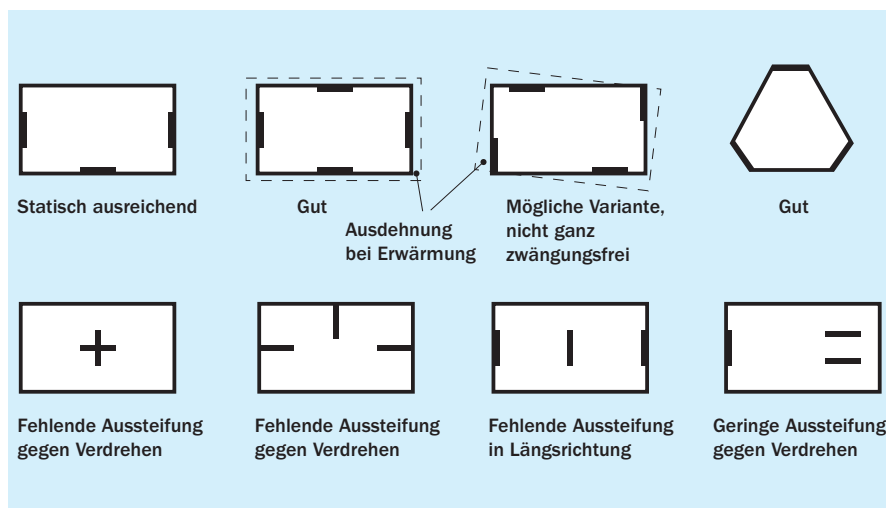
Günstige und ungünstige Anordnung von Wandscheiben im Grundriss (nach [14])
